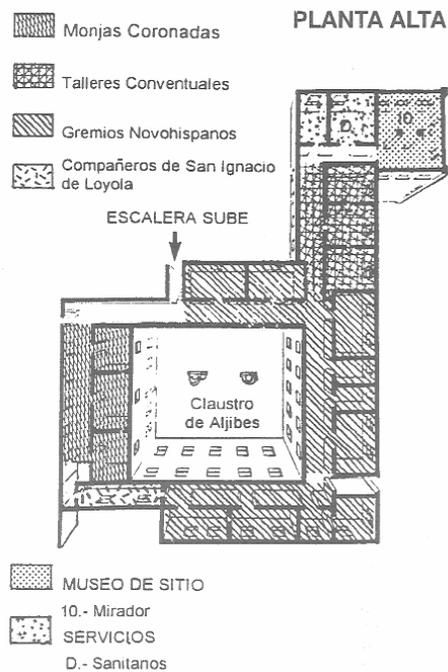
Planta Alta. Museo Nacional del Virreinato, Tepetzotlán, Edo. de México
